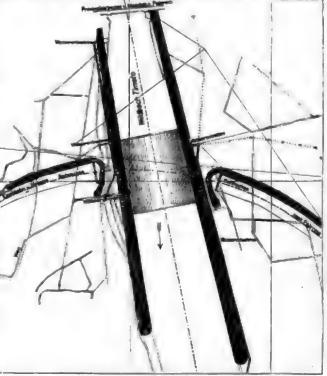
Lageplan der Bahn-Unterführung unter dem Wildwasser
